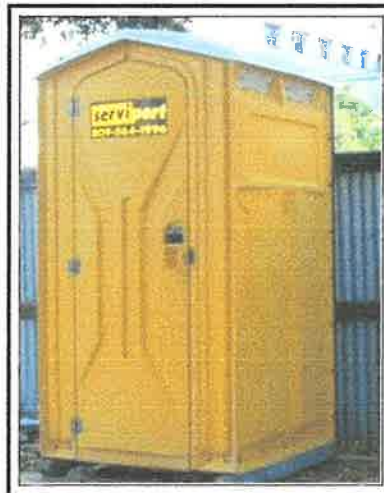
Tipo de baño portátil que puede ser utilizado en el proyecto.
